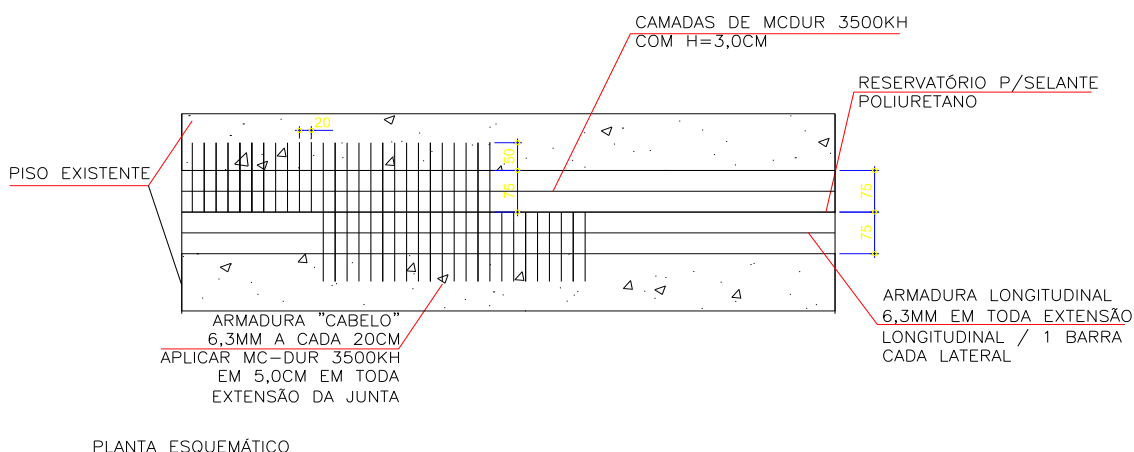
PLANTA ESQUEMÁTICA JUNTA PISO OPERACIONAL
